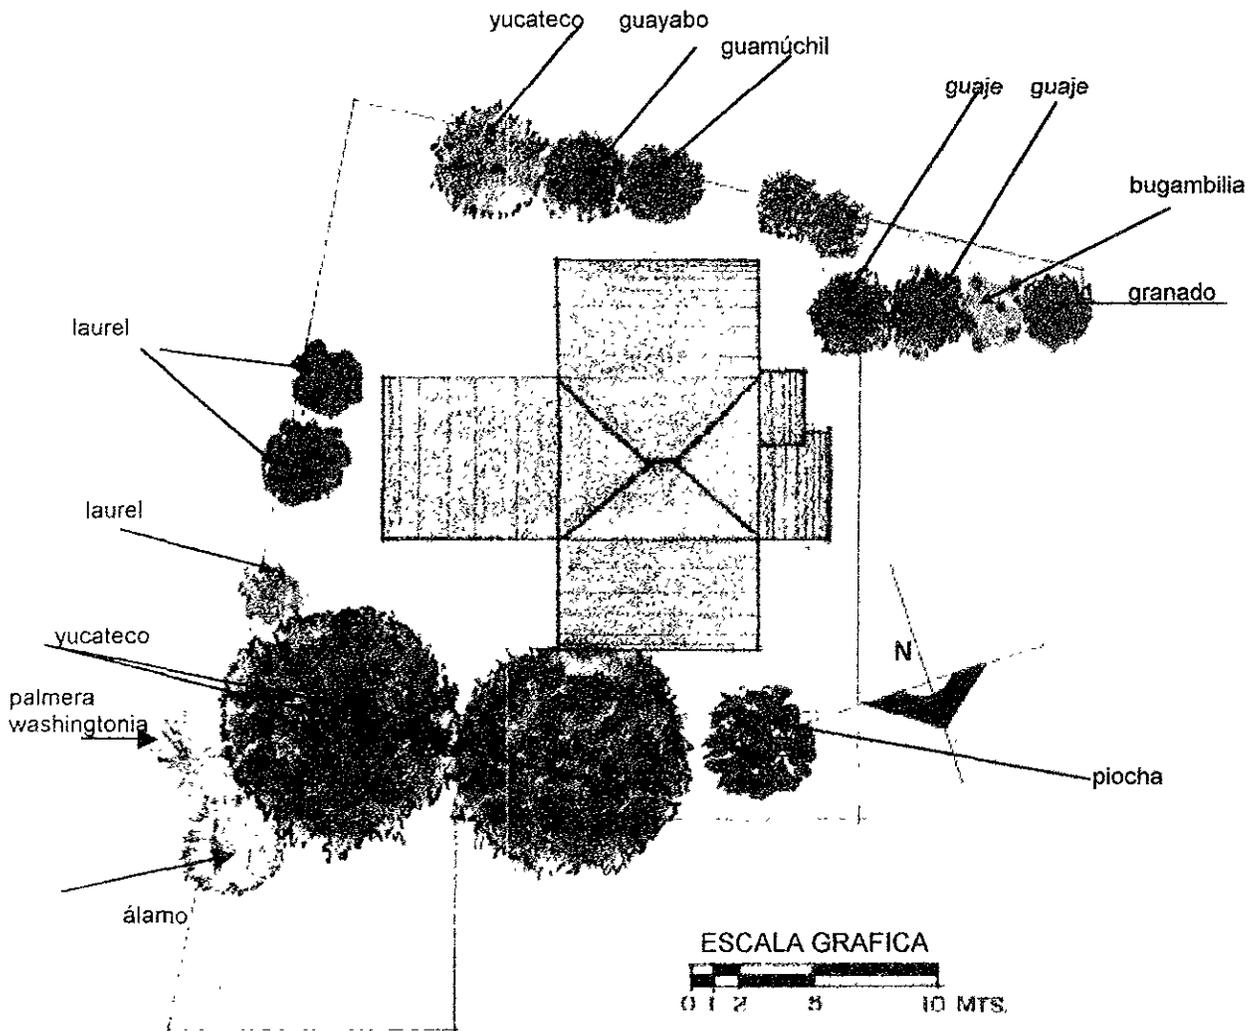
Planta de conjunto y paleta vegetal, caso 15
